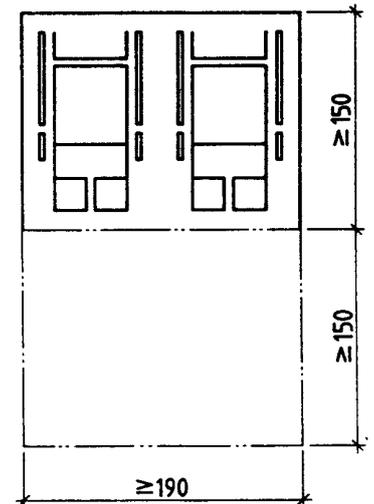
Platzbedarf für den Rollstuhl-abstellplatz und Bewegungsfläche
